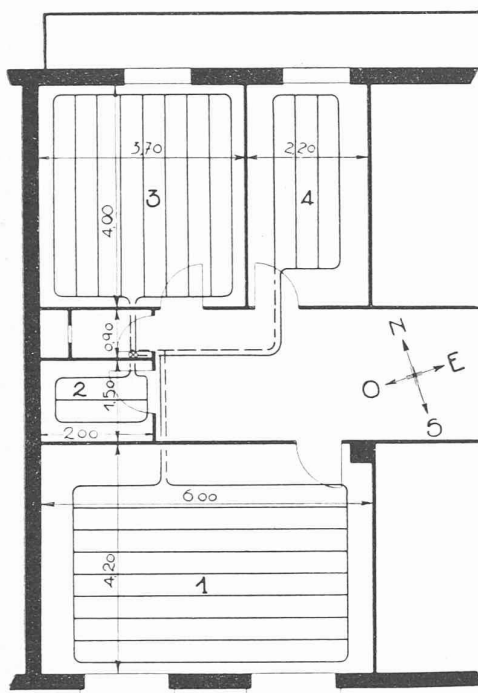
Exemple de disposition des surfaces de chauffe.
